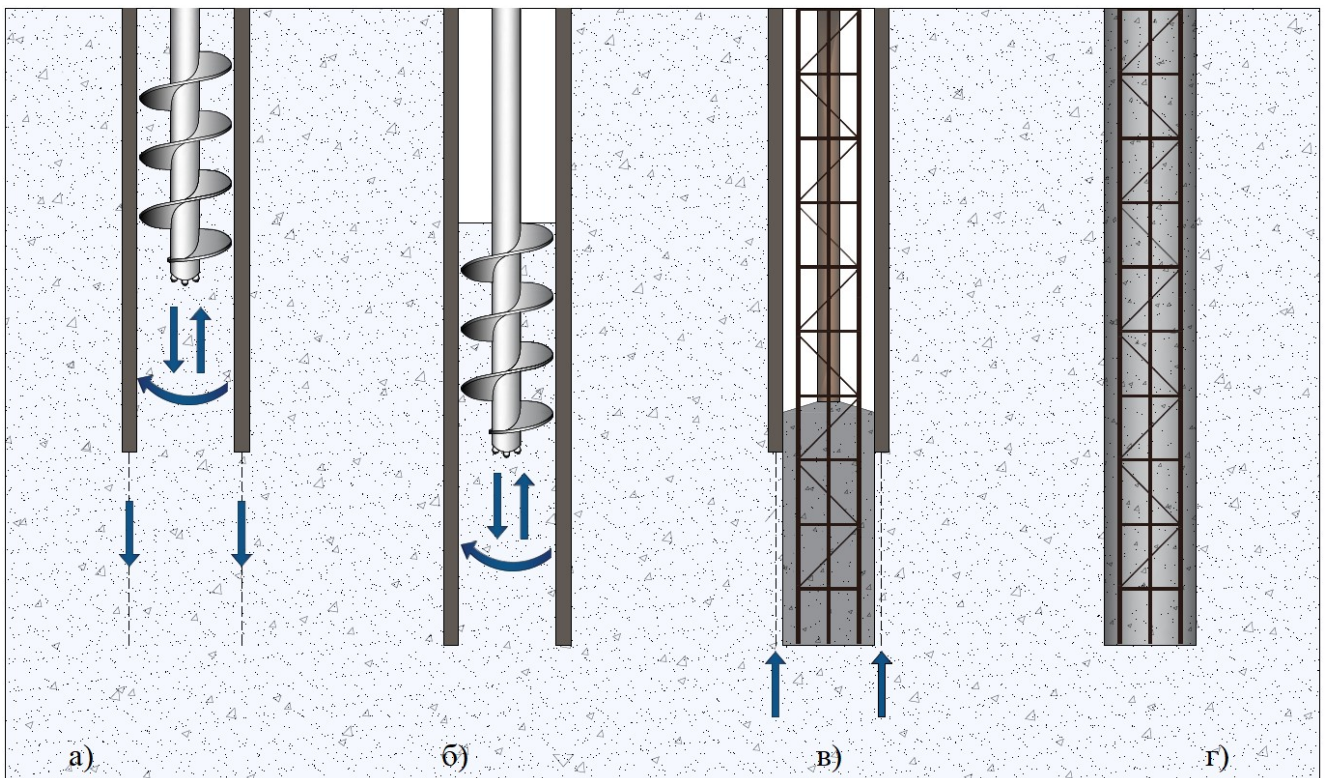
Технологический цикл устройства: а, б) бурение скважины коротким проходным шнеком под защитой обсадной трубы; в) погружение арматурного каркаса и бетонирование скважины; г) готовая свая
